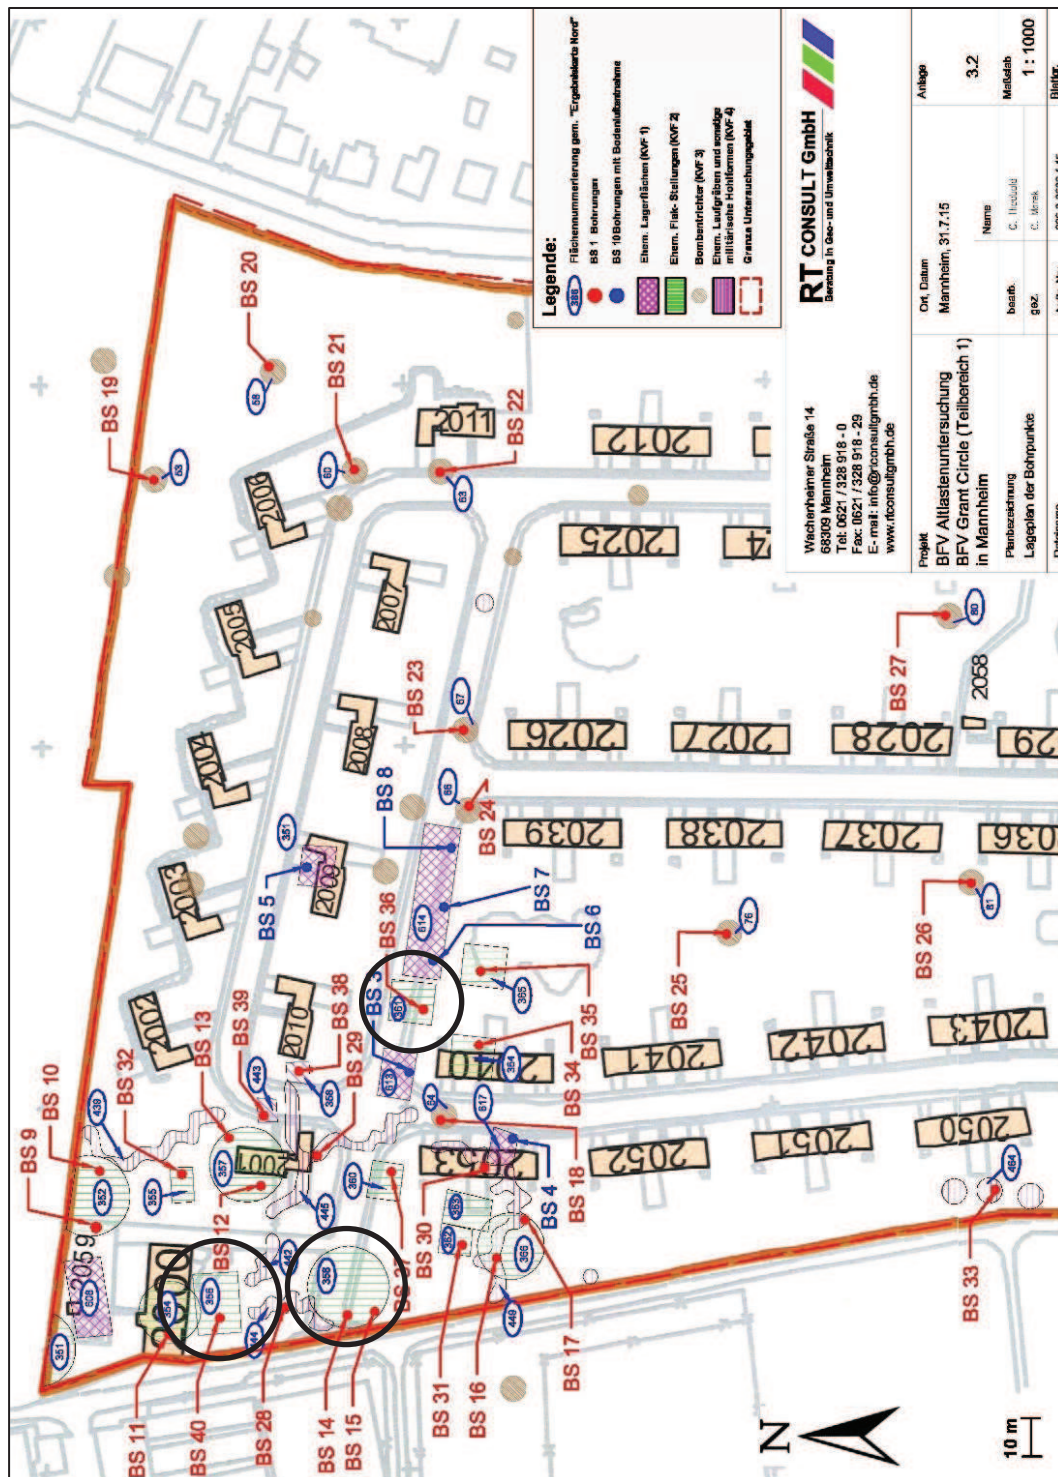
Altlastengutachten; Lageplan der Bohrpunkte
